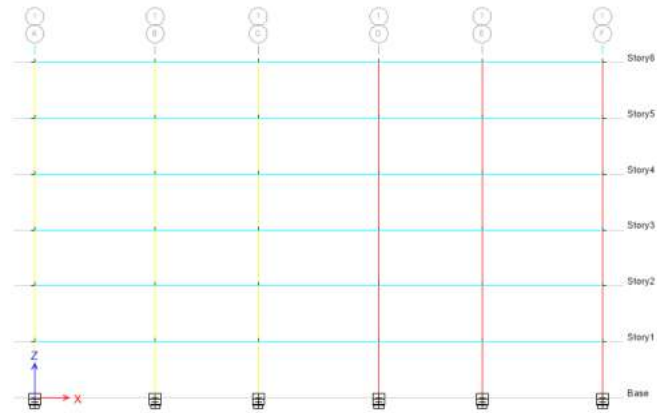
Edificio con aisladores sísmicos LRB (vista en elevación) edificio de 6 pisos irregular.
